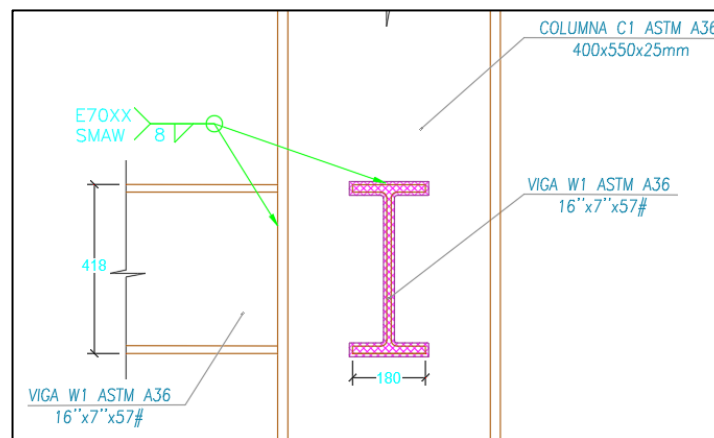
Conexión entre columna y viga - Sistema estructural mixto.
